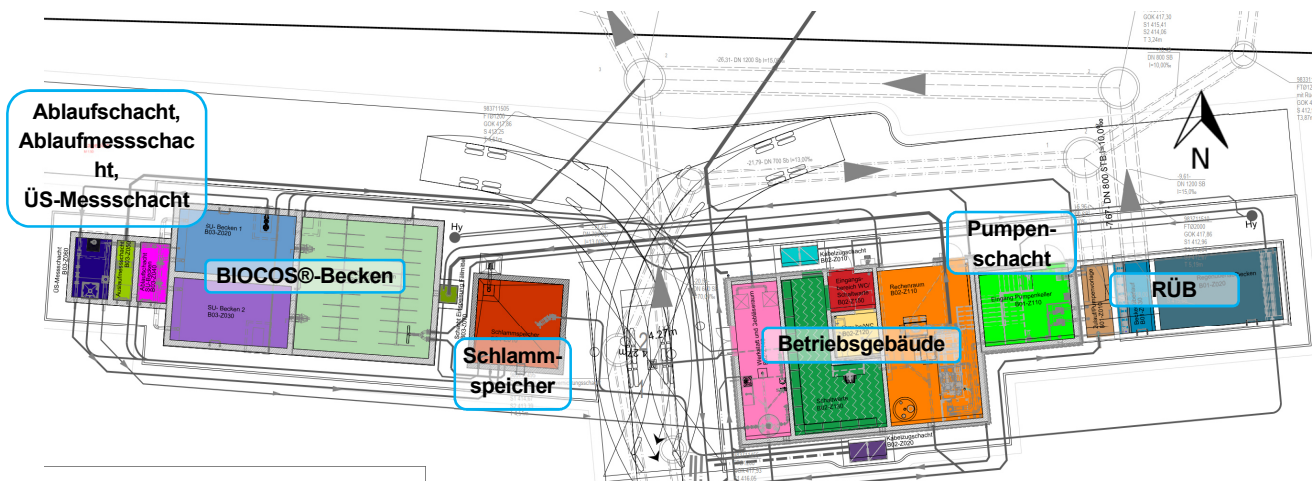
Ausschnitt Lageplan - Anordnung der Bauwerke der Kläranlage
